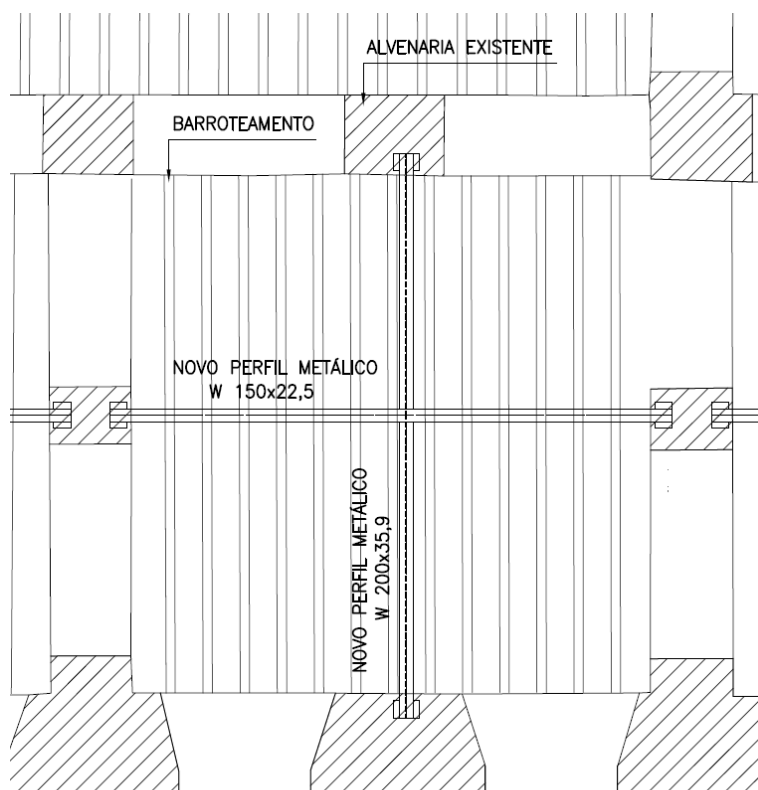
Esquema estrutural para reforço do piso do novo colégio Eleva em Botafogo (antiga Casa Daros) com acréscimo de perfis metálicos - planta.
